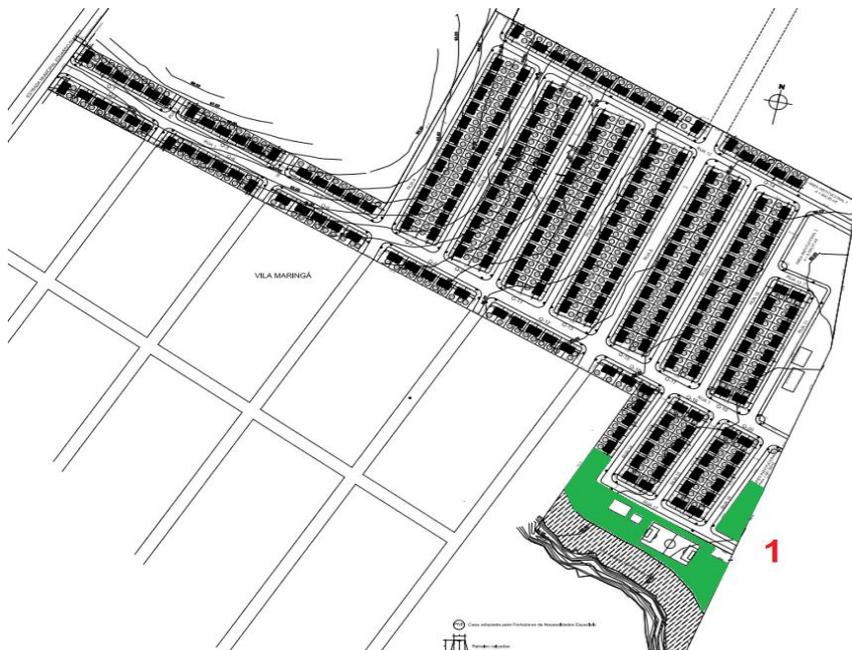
Planta de implementação do loteamento Zilda Arns com indicativo da localização das áreas verdes. Fonte: Secretaria de Município de Habitação e Regularização Fundiária de Santa Maria (adaptado)
